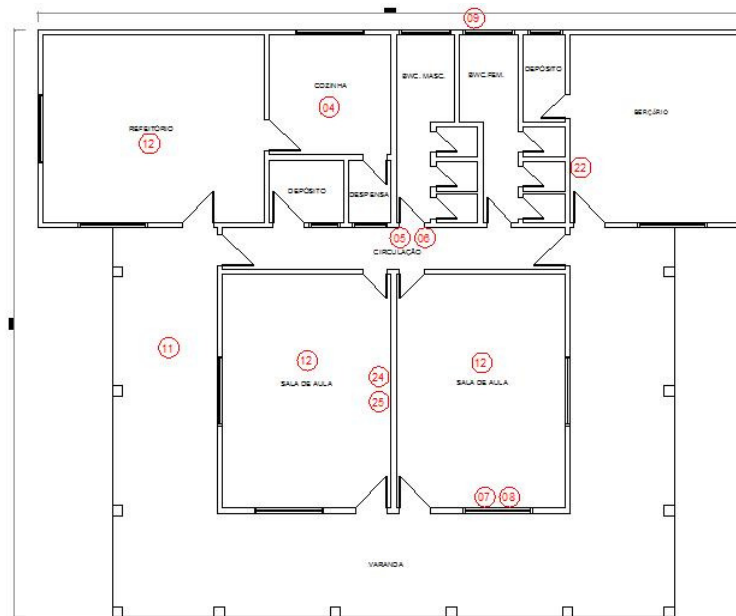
Planta Baixa creche Peixinho Dourado – Balneário Rincão
